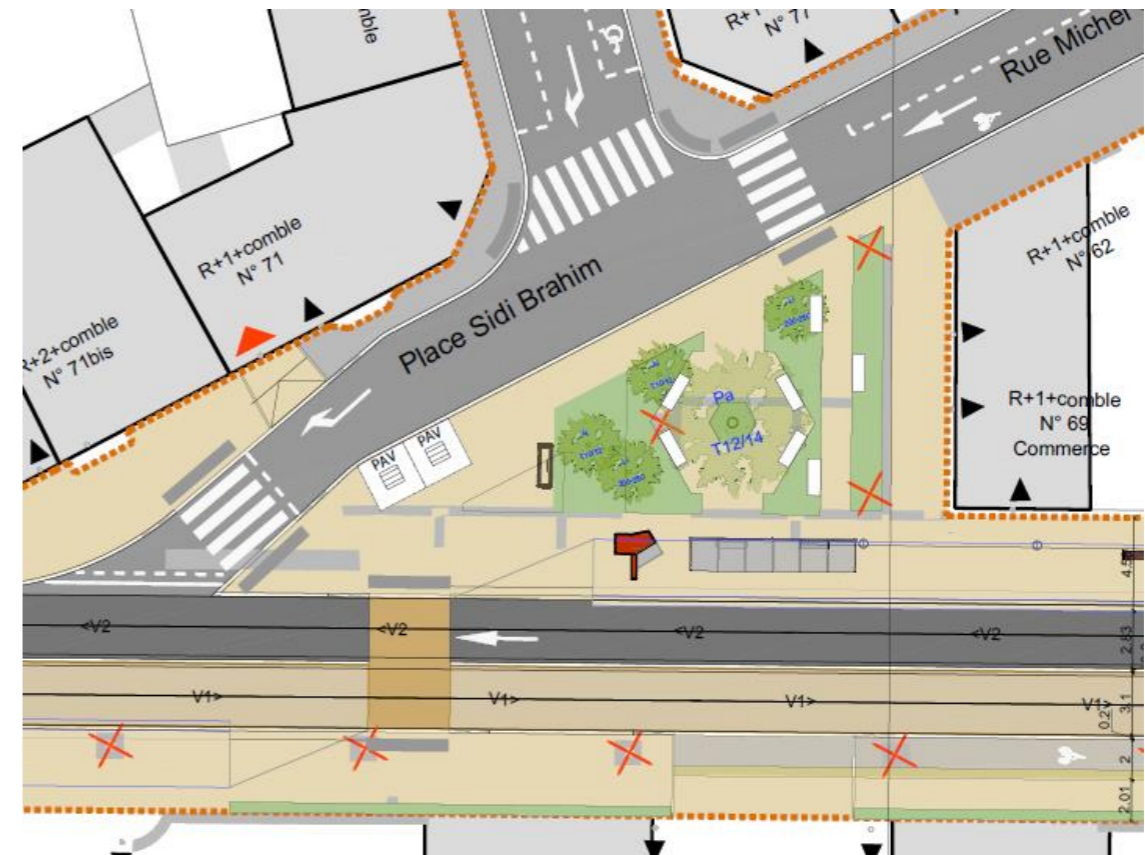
plan de principe de l'insertion paysagère sur la place Sidi Brahim
